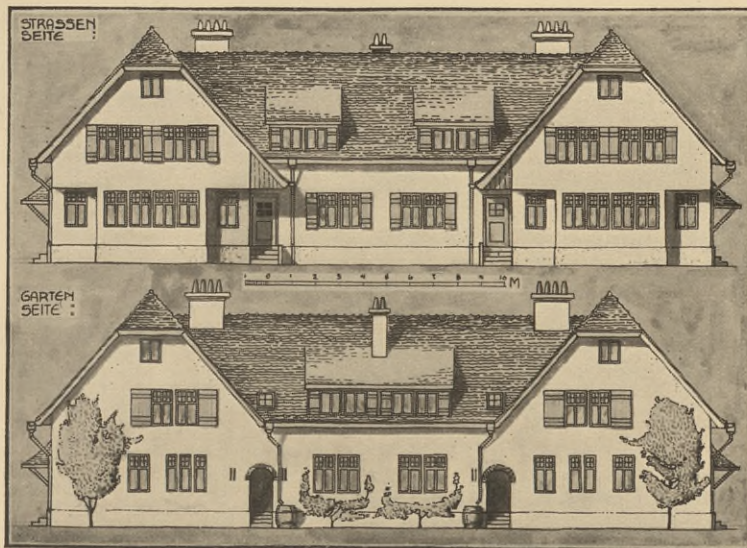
Vier-Häuser-Gruppe mit Einfamilienhäusern (aus: Berlepsch-Valendäs „Kleinwohnhaus-Anlagen im künftigen Städtebau“).
